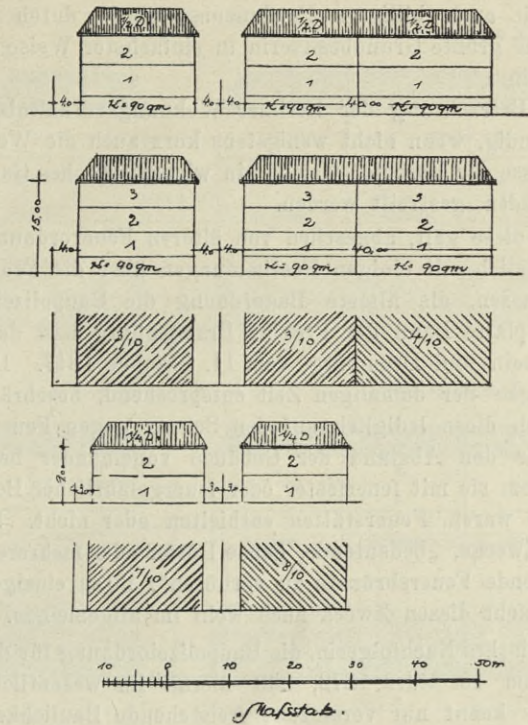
Landhausmässige Bebauung und Kleinhausbauten nach der B. P. O. vom 5. Dezember 1892
